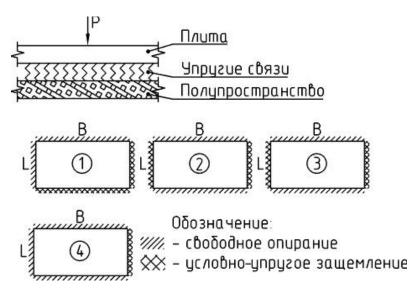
Расчетная схема и граничные условия асфальтобетонной плиты: 1, 2, 3 – полубесконечной длины; 4 – бесконечной длины
